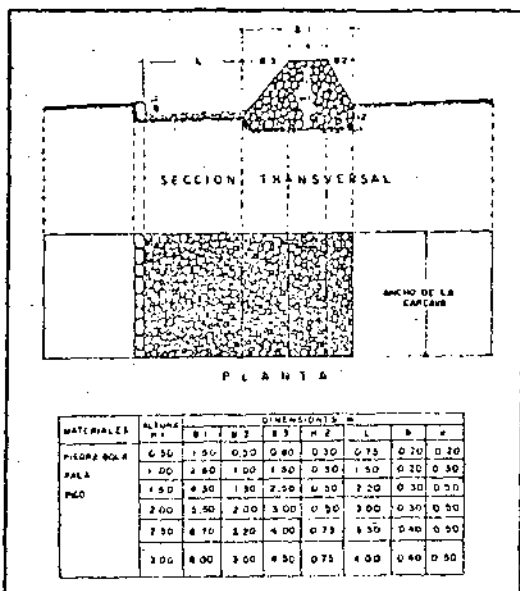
Características de las presas de control de azolves por construir con piedra bola.
